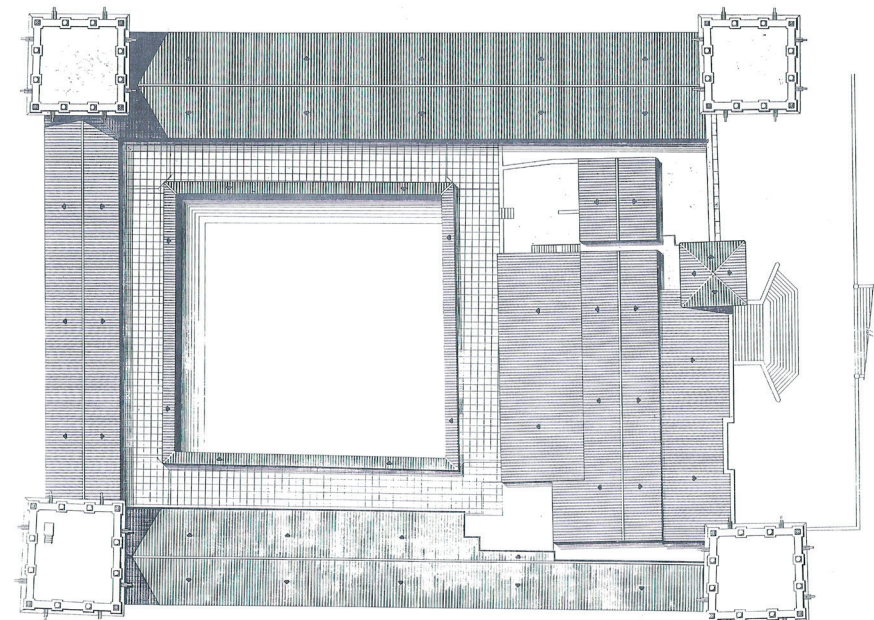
Planta de cubiertas del Monasterio de Santa María de El Puig (Dominguez Rodrigo)
